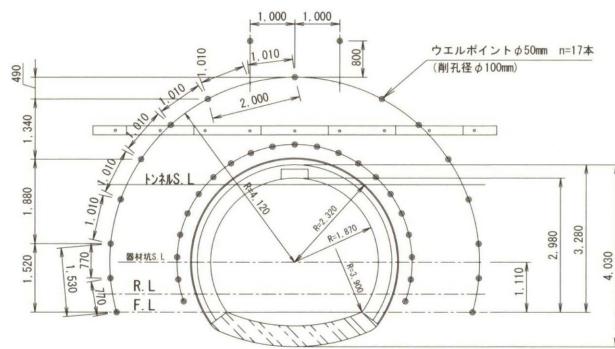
No. 2 器材坑 ウェルポイント断面図
